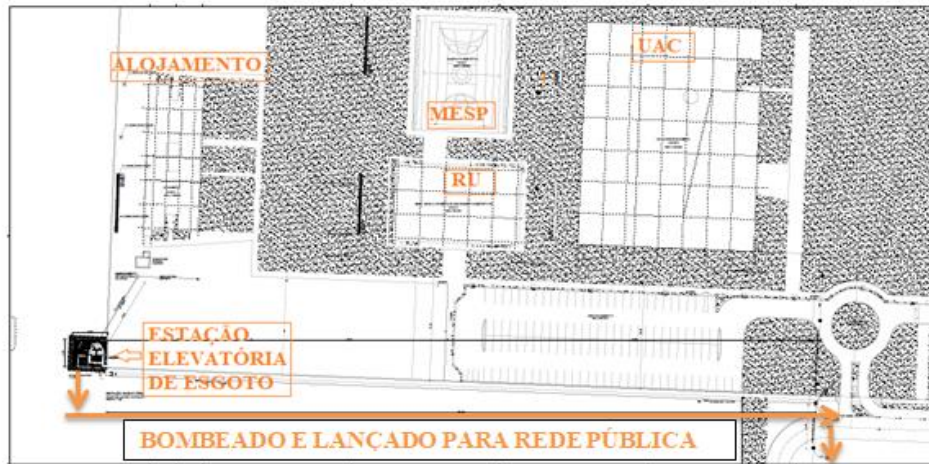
Planta baixa da FUP. Foto: disponibilizada pela instituição (modificada pela autora).
